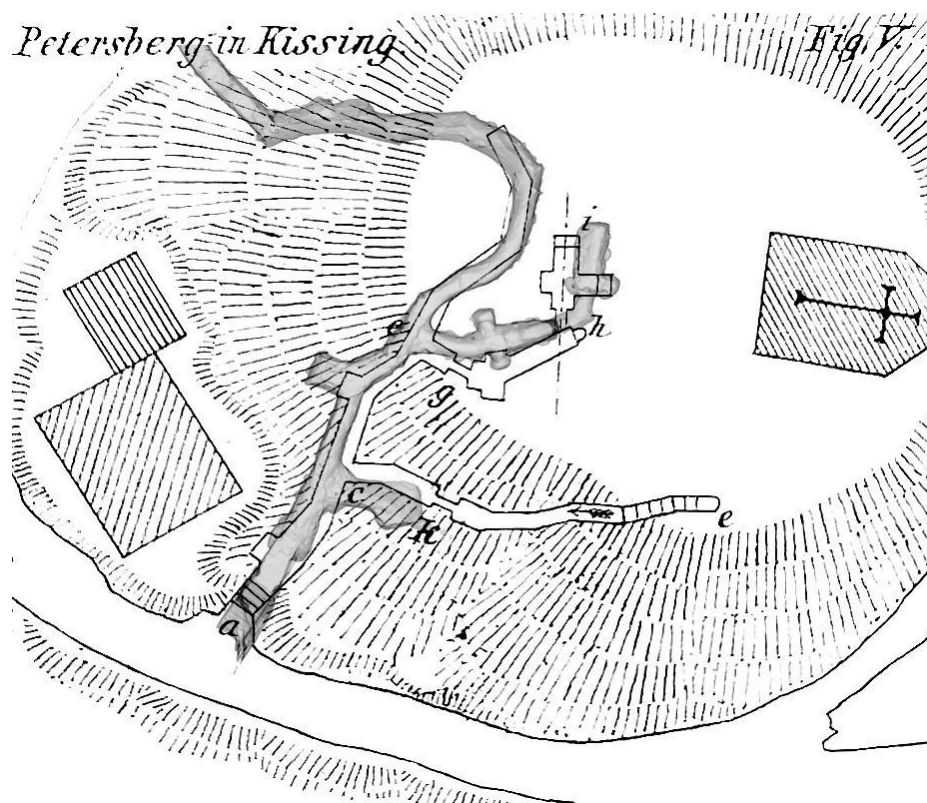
Überlagerung des vermessenen Grundrisses (grau ausgefüllte Fläche) mit der Grundriss-Karte von Hartmann 1879.
